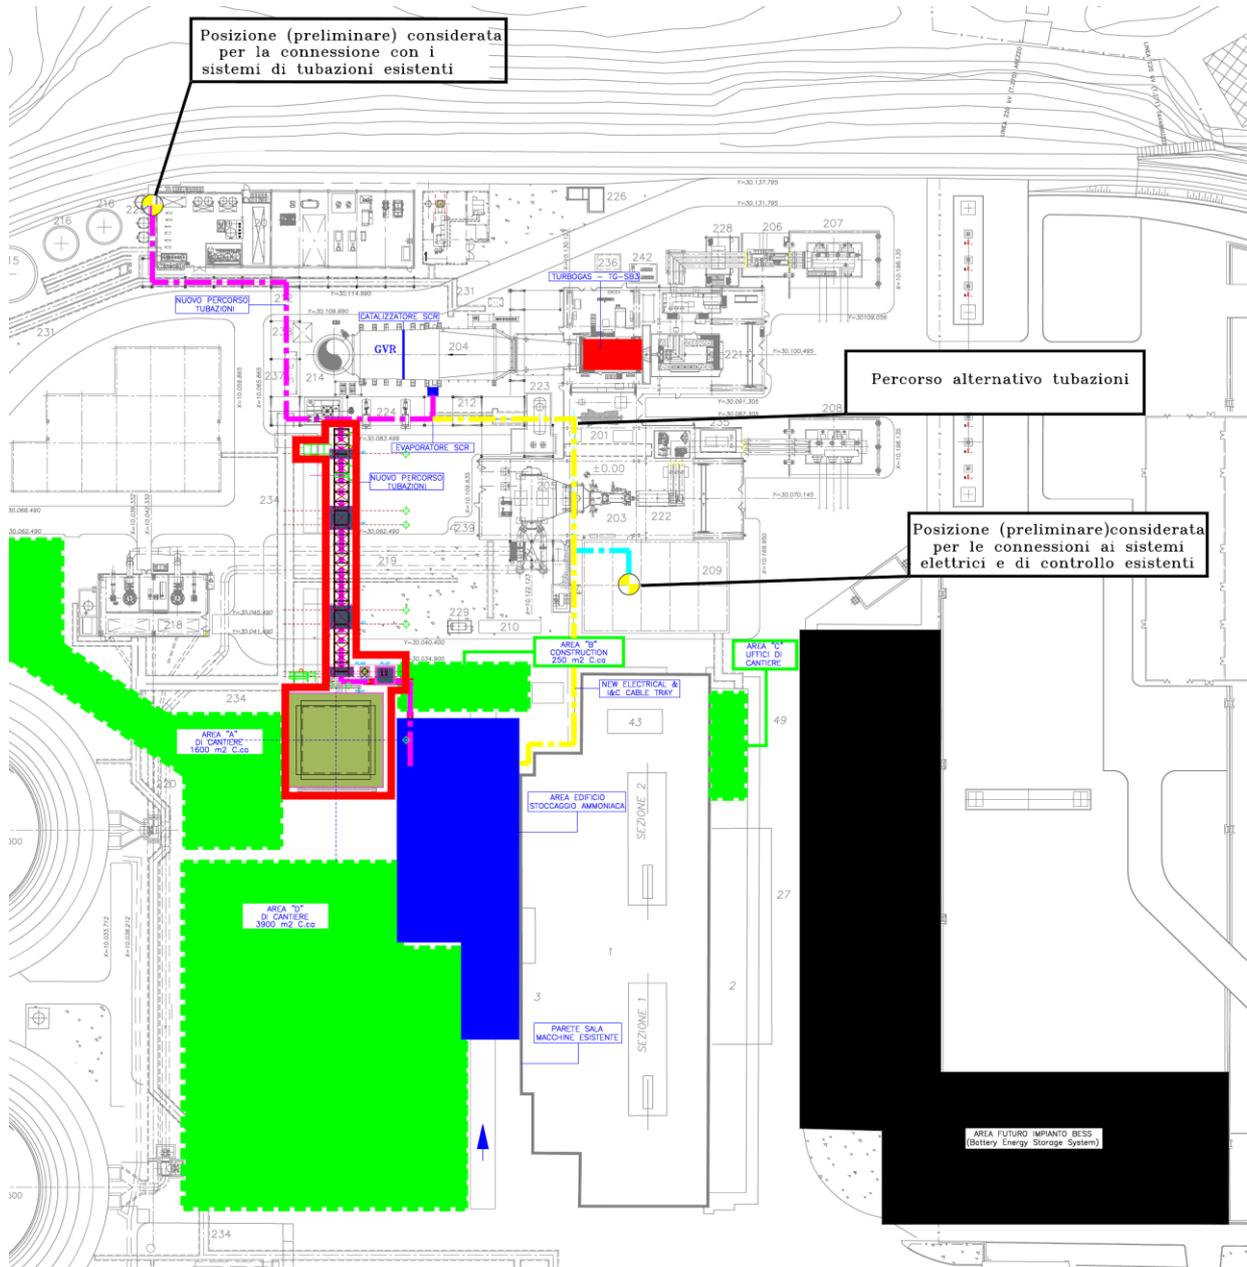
Stralcio della planimetria delle opere (nel poligono blu); sono inoltre rappresentati l’impianto BESS (poligono nero) e l’impianto TESS (poligono rosso) e le aree di cantiere (verde)
